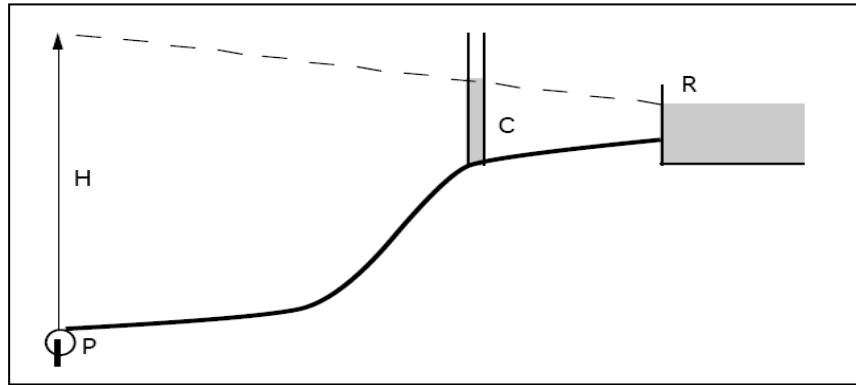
Cheminée d'équilibre sur une conduite de refoulement
